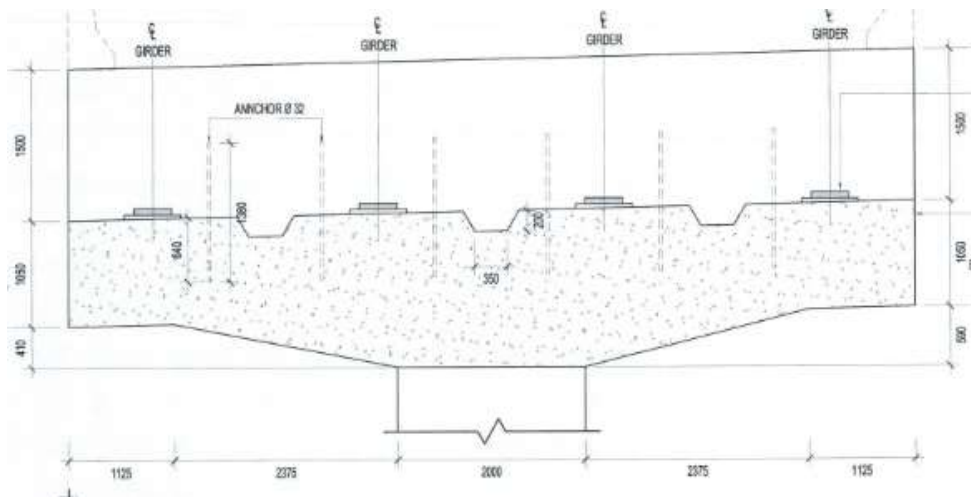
Denah dan bentuk struktur *pile cap* Pier PN5
